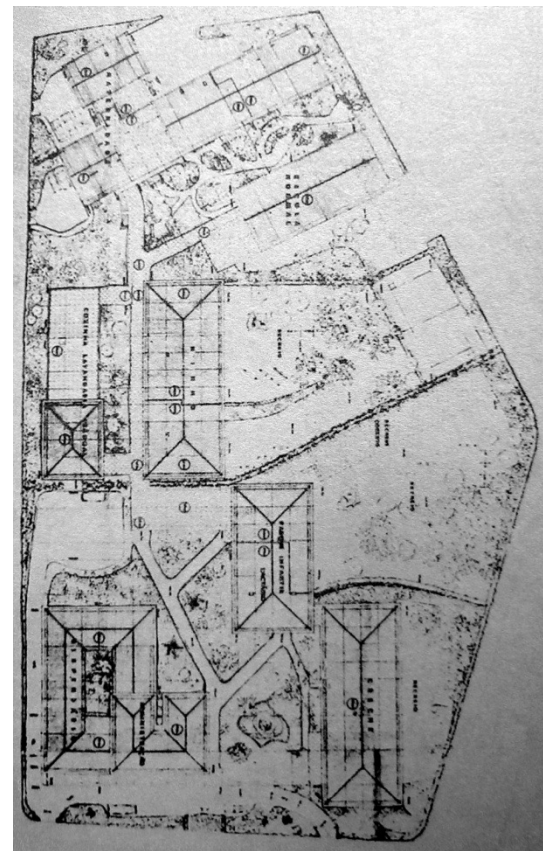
Planta de implantação do projecto do Instituto Maternal de Coimbra.
